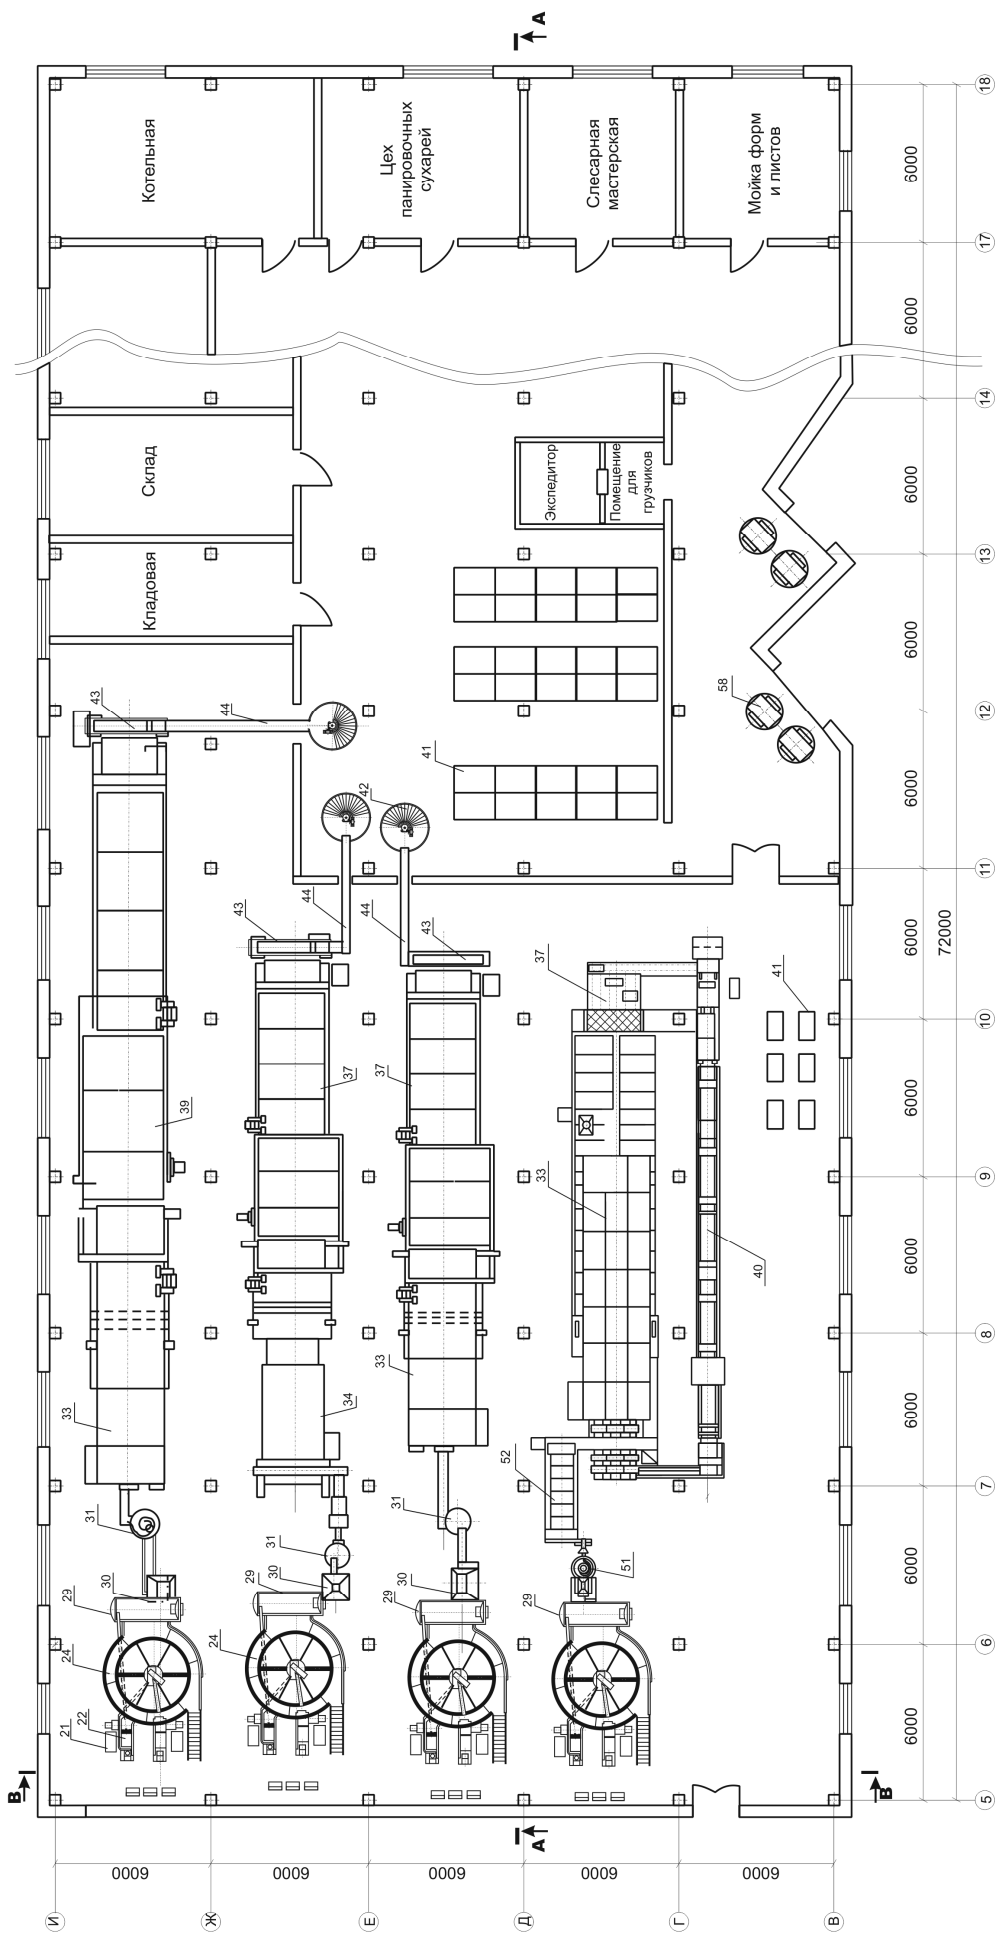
План первого этажа с компоновкой оборудования [2]
